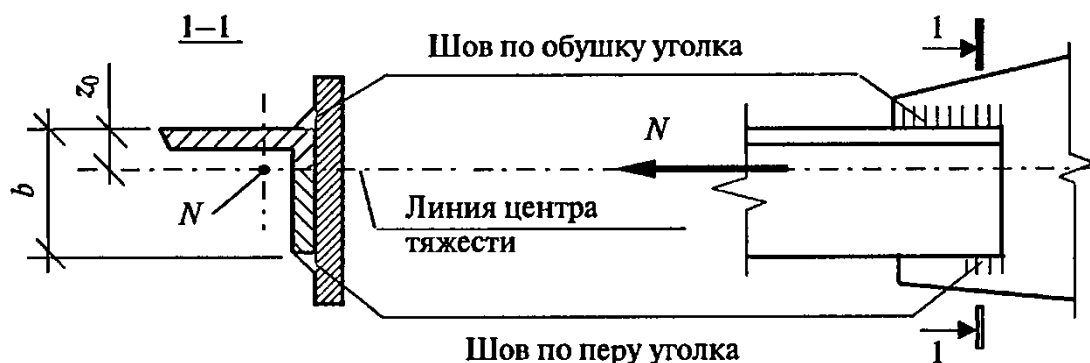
Крепление угловыми сварными швами уголка
